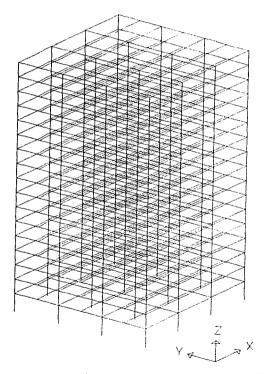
Modelo matemático tridimensional de la estructura de 17 niveles
